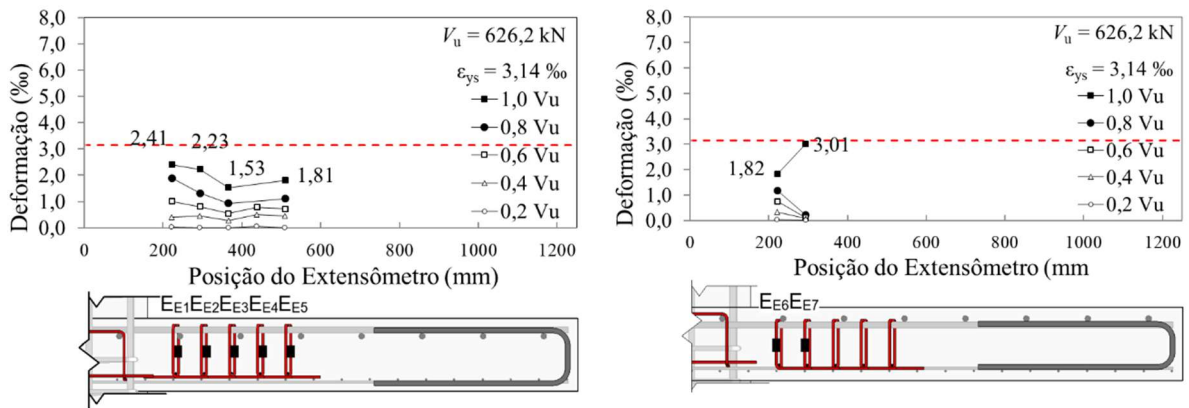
Deformação da armadura de cisalhamento na laje CTA
